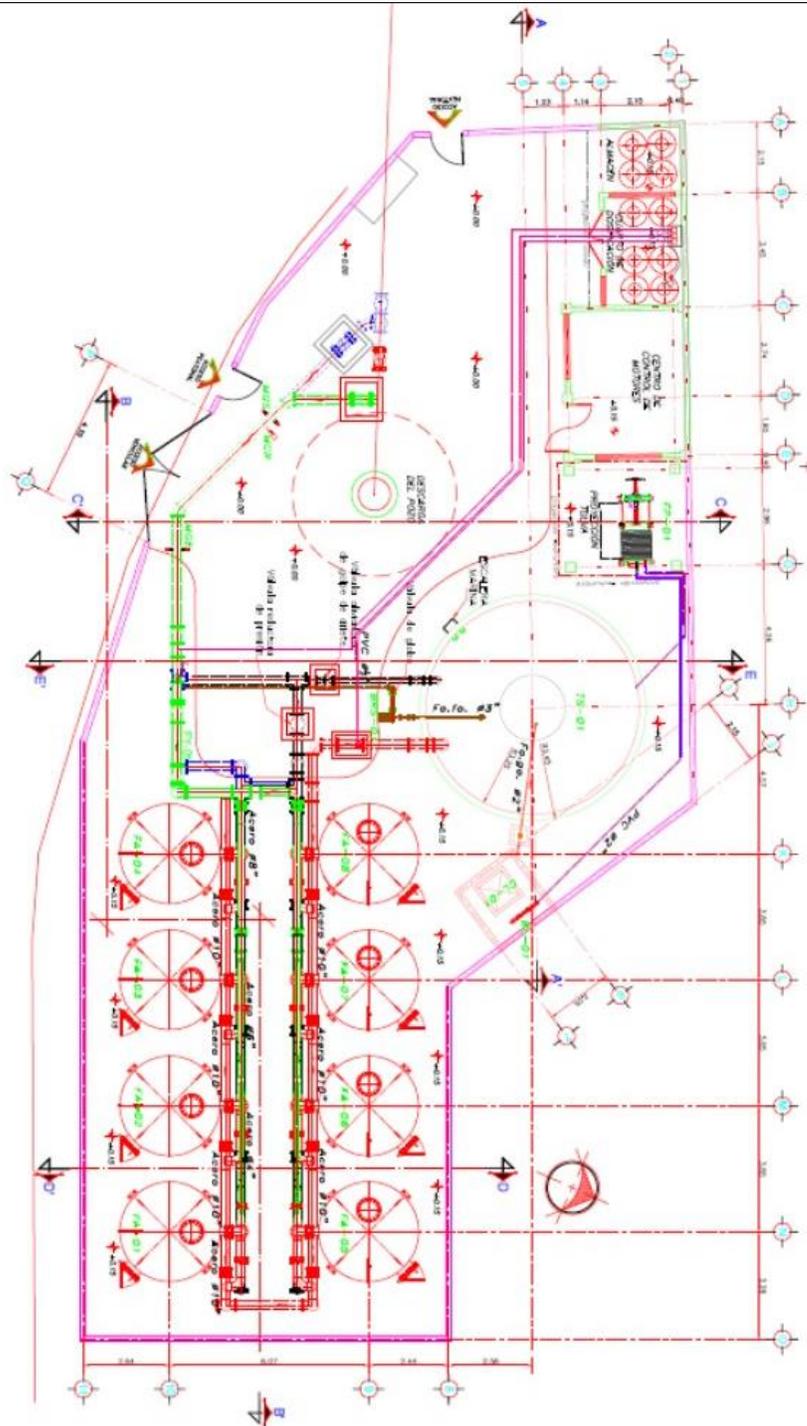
Arreglo general de planta proyectada en nuevo terreno, pozo No. 5
